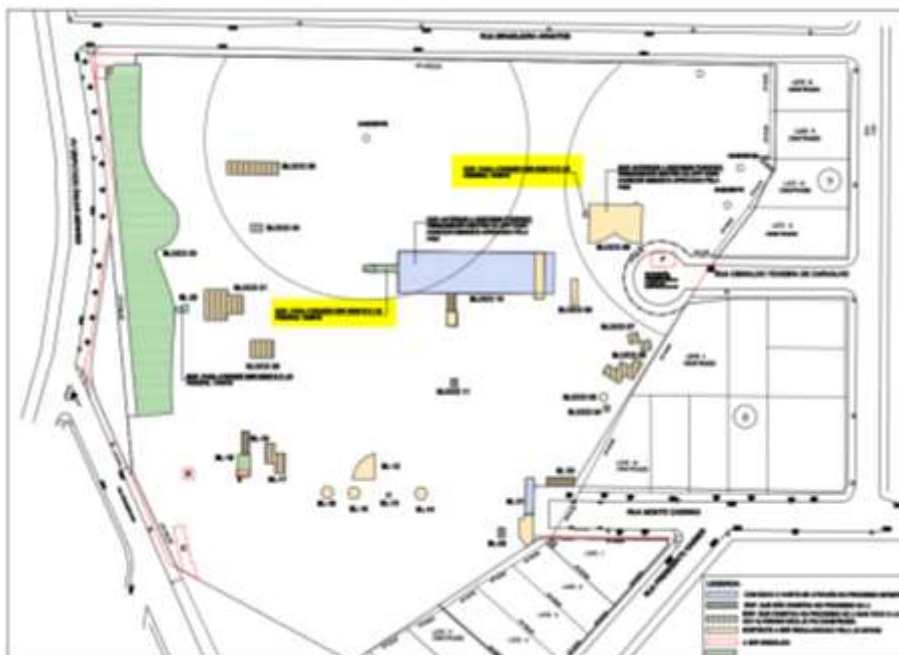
Localização dos blocos 08 e 10 onde haverá construção de acessos para atendimento da Lei Federal Nº 13.146 de 06/07/2015.
